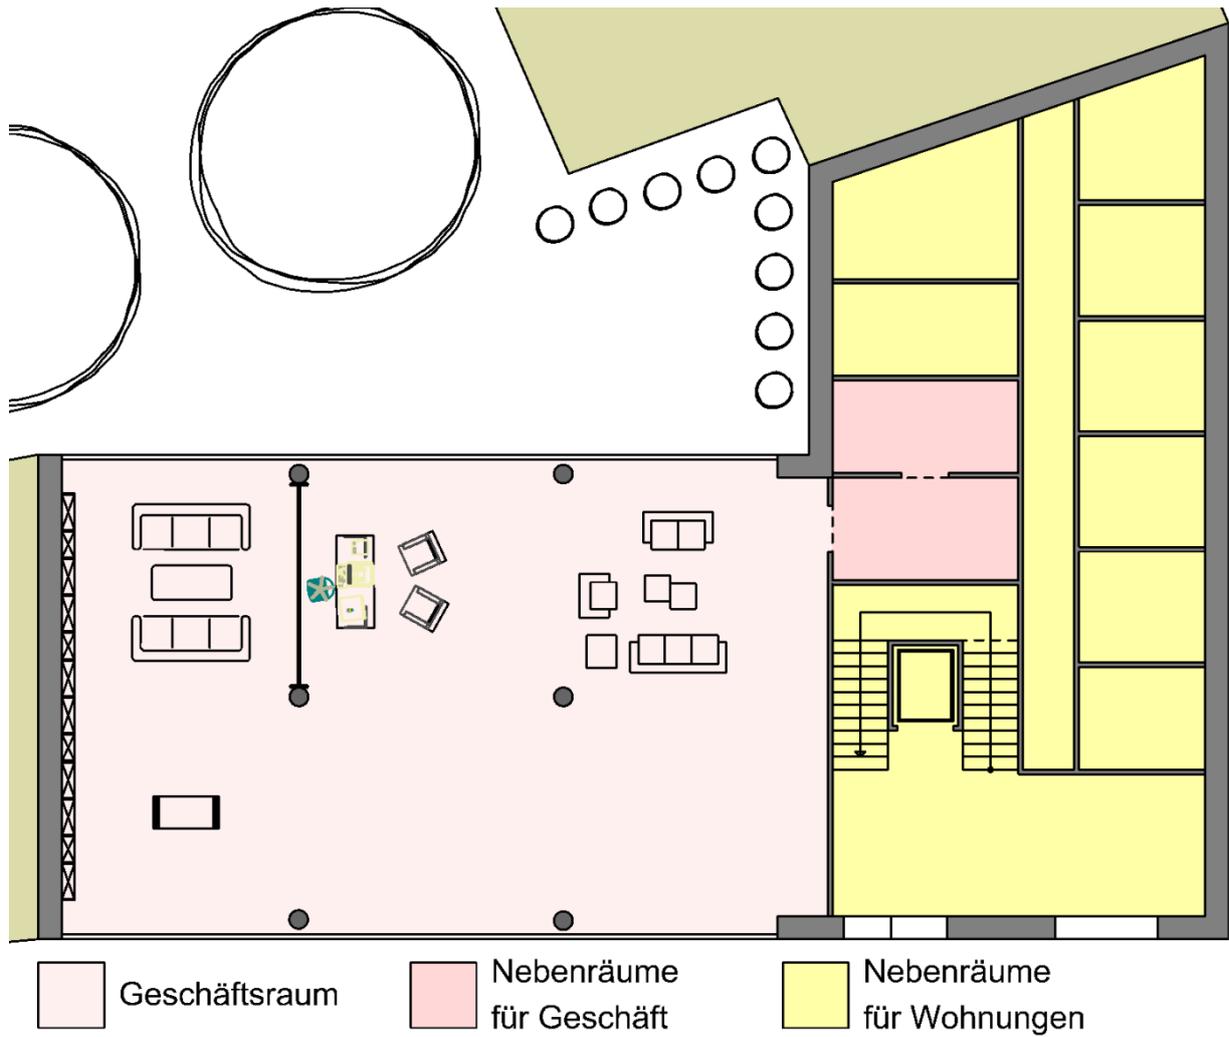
Grundriss EG (Funktionszonierung)
